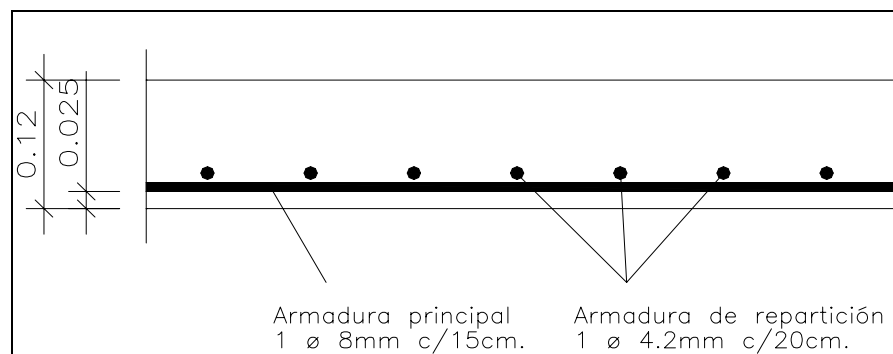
Disposiciones de armaduras en losas macizas del sector húmedo de las torres.
